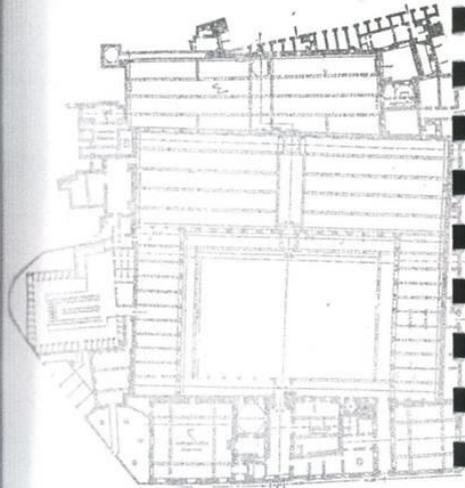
مسقط أفقي للمسجد الجامع بمدينة بغداد (عن: كريزول).
